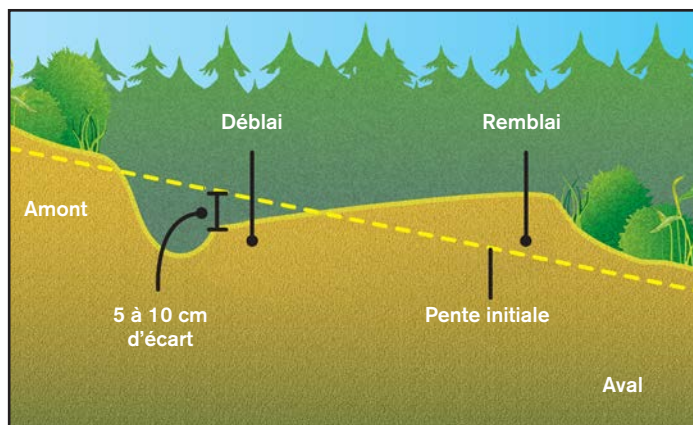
Vue en coupe d'un sentier à flanc de montagne.
